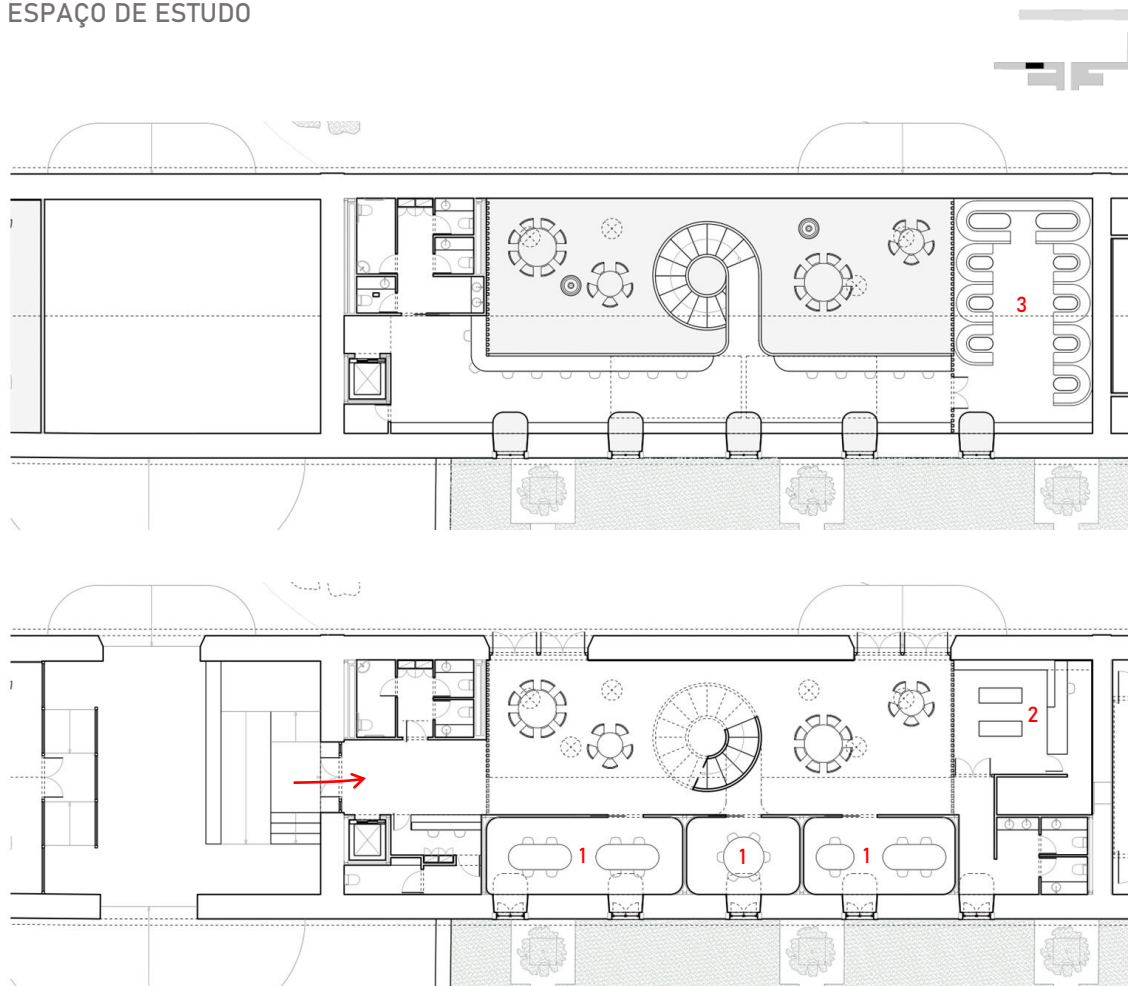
| Plantas do piso 0 e do piso 1 do espaço de estudo (de baixo para cima, respectivamente) (sem escala).
